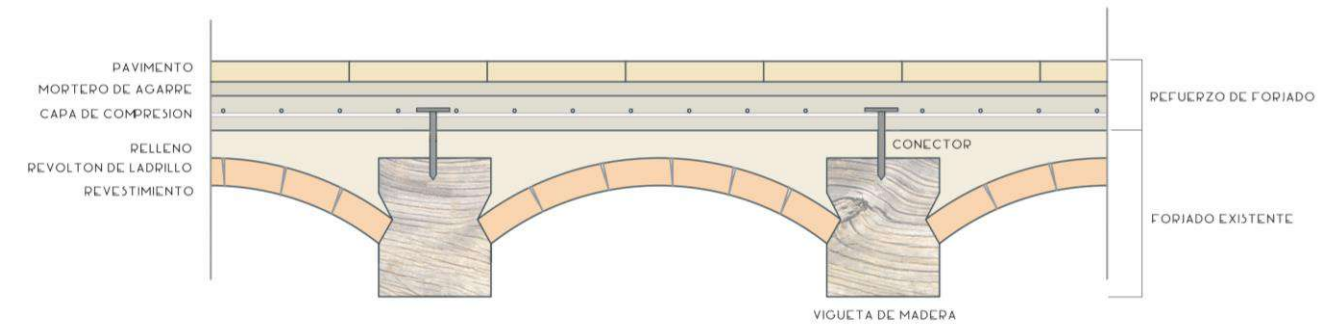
Detalle de refuerzo de forjado. Fuente: Elaboración propia
